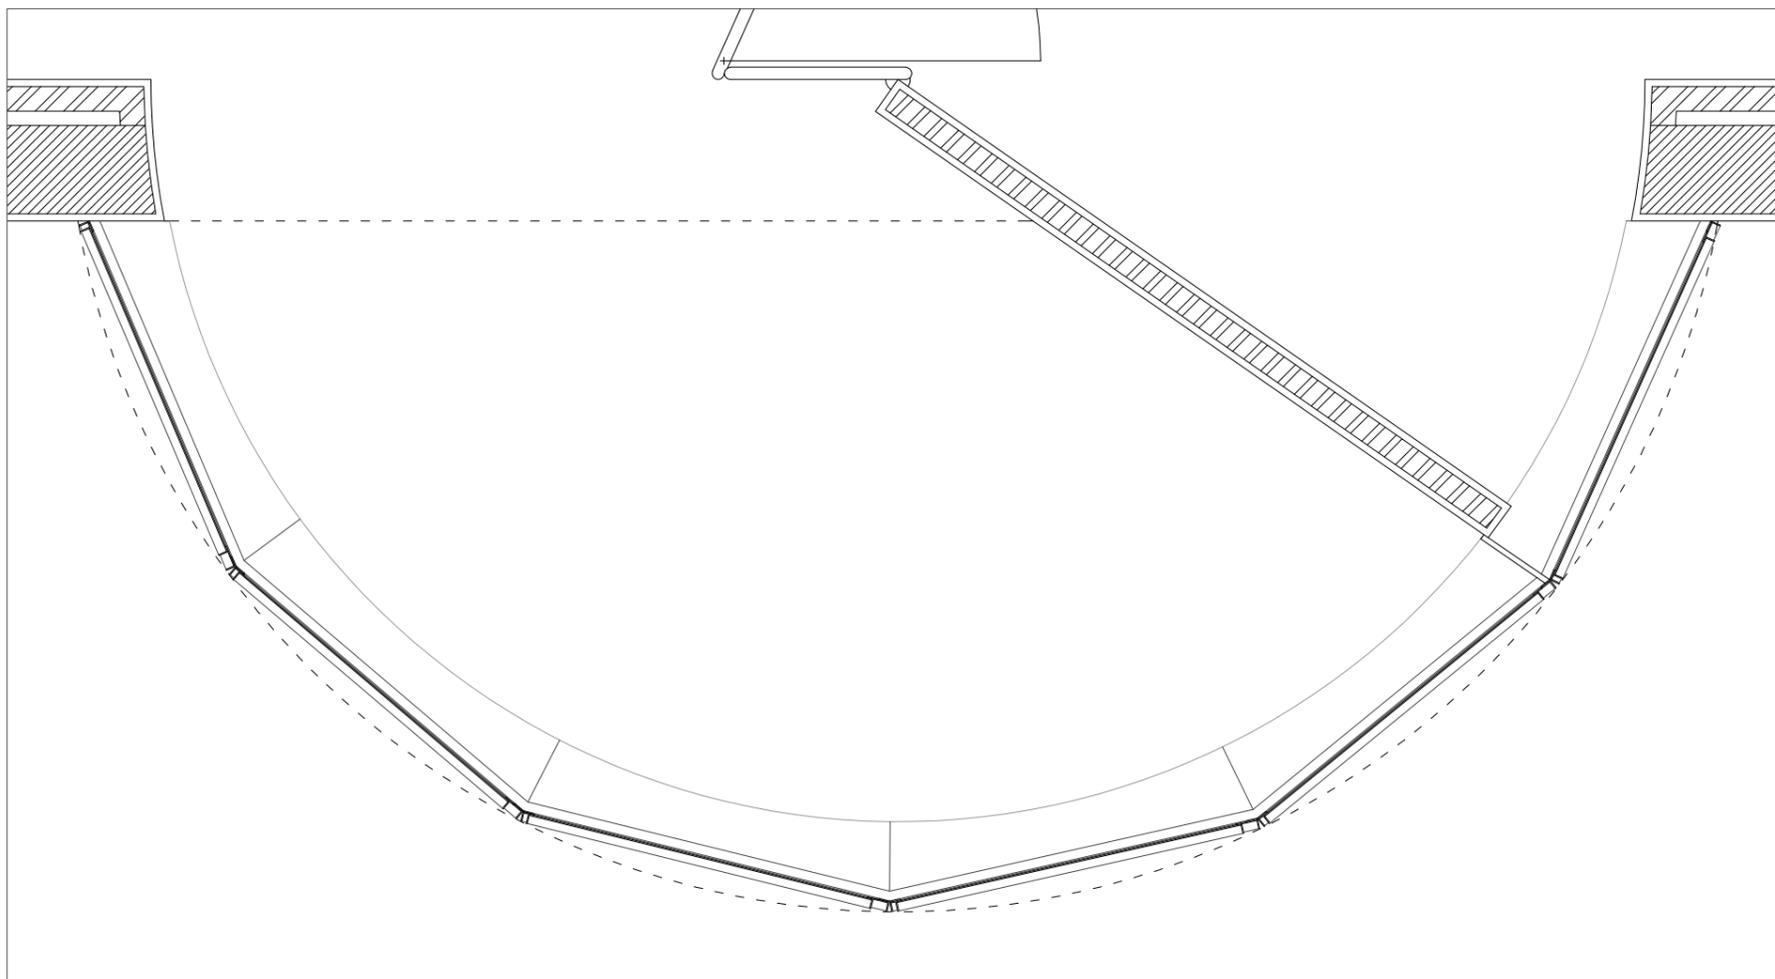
Planta da Bow Window do Piso 1 — Desenho Original | Escalas 1:20 e 1:5
